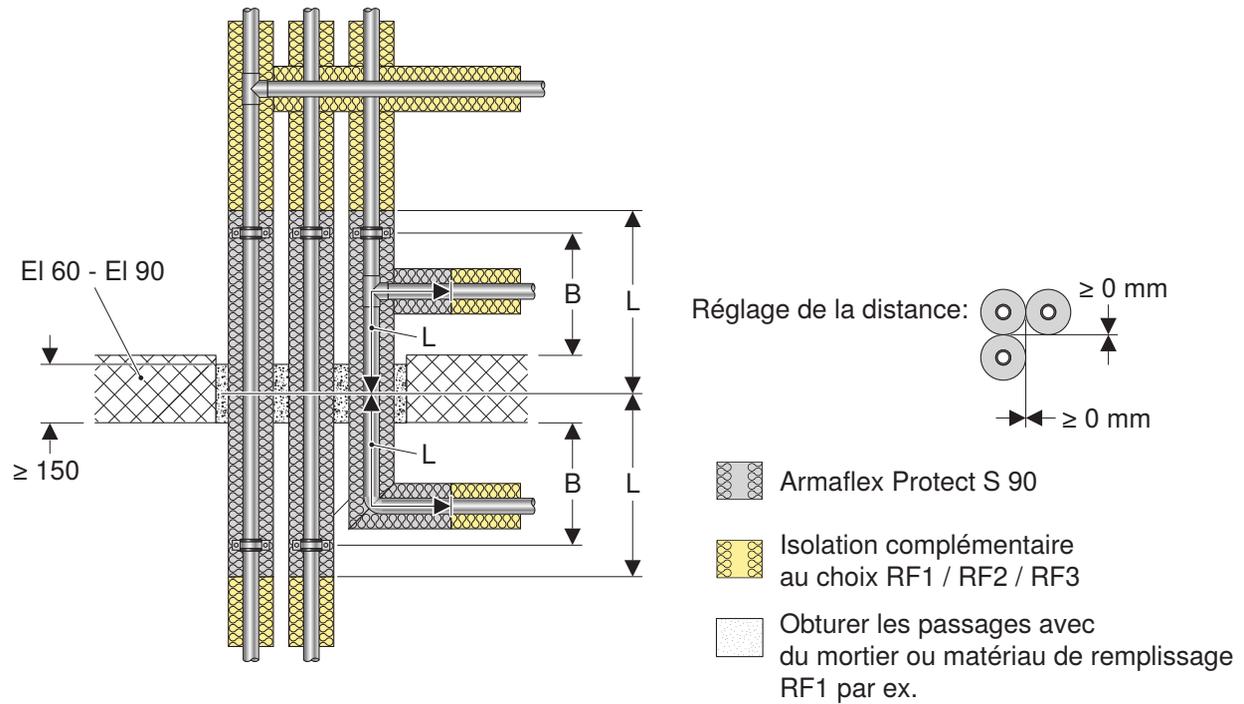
Traversée de dalle supérieure avec Geberit Mepla ou Geberit PushFit et isolation Armaflex Protect
